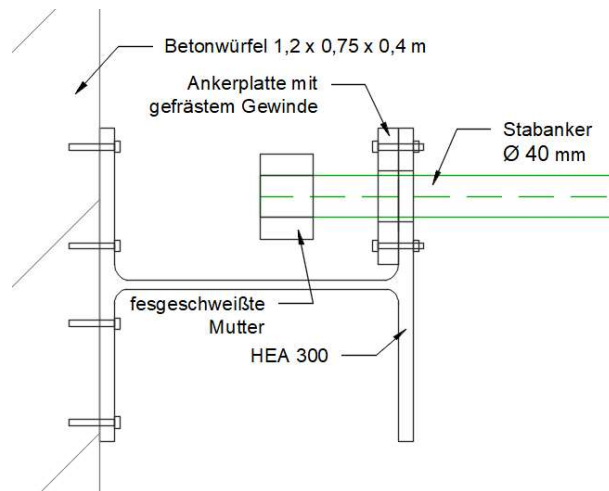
Detail Anschluss Stab an Betonwiderlager Variante 1
